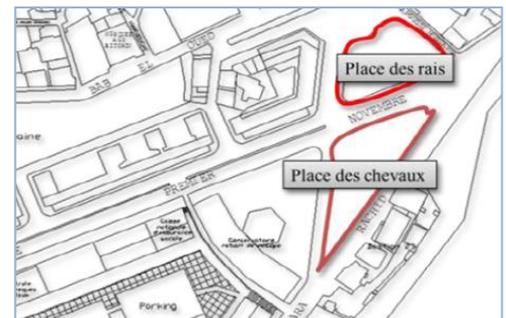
Vue en plan de la place des Rais et des chevaux.
